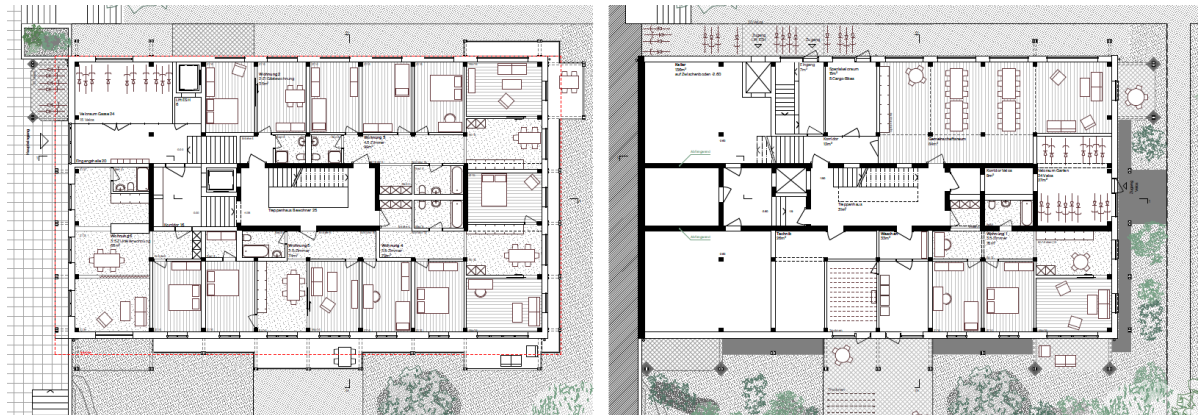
Grundrisse Gassengeschoss (links) und Gartengeschoss (rechts), ohne Masstab
